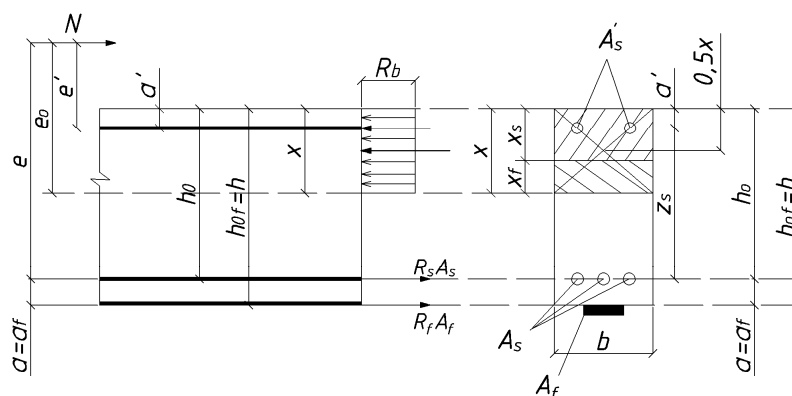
Расчетная схема и эпюра напряжений в нормальном к продольной оси сечению внецентренно-сжатого элемента, усиленного продольной композитной арматурой.
